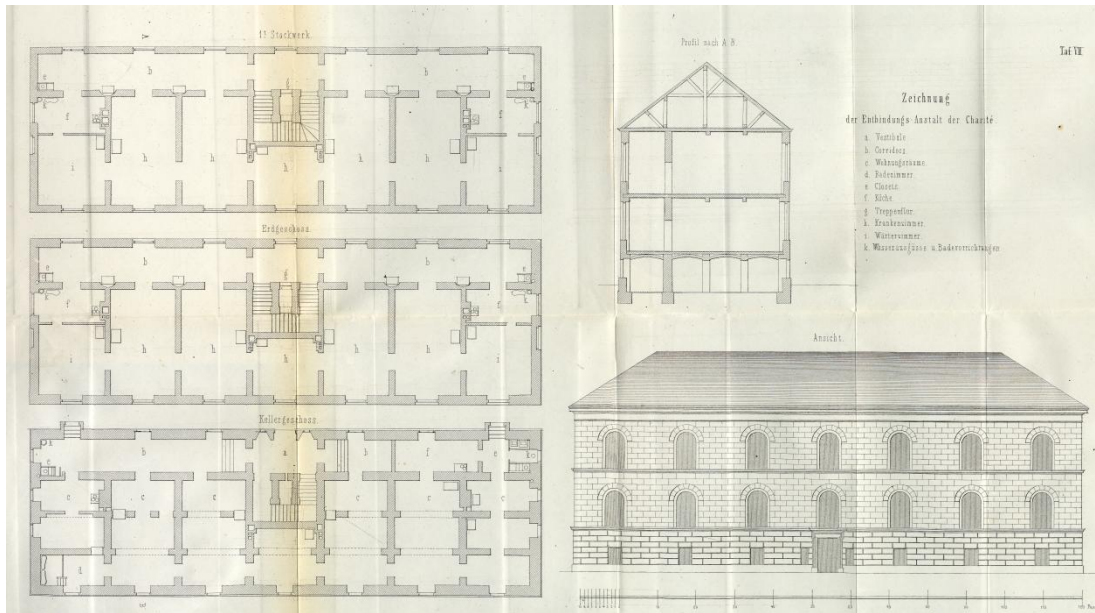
Ansicht und Grundrisse des Pockenhauses (Esse 1857 Tafel VII)
